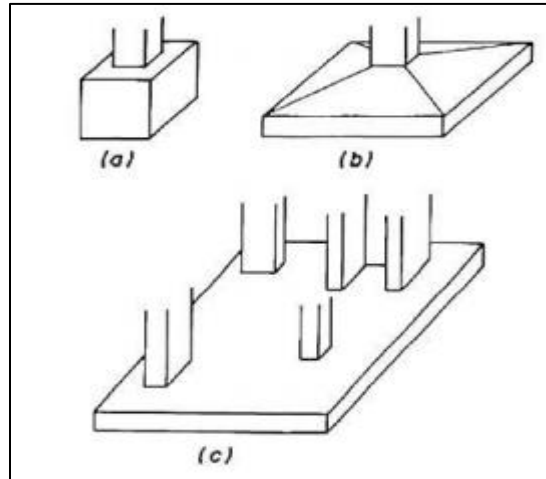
Tipos de fundações superficiais: Bloco (a), sapata (b) e radier (c)
